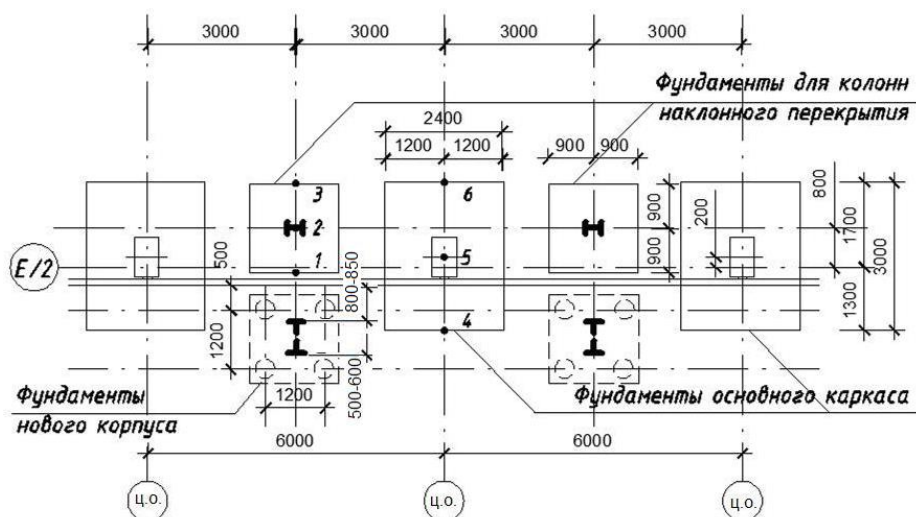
Фрагмент схемы расположения фундаментов существующего корпуса и свайных фундаментов проектируемого здания
